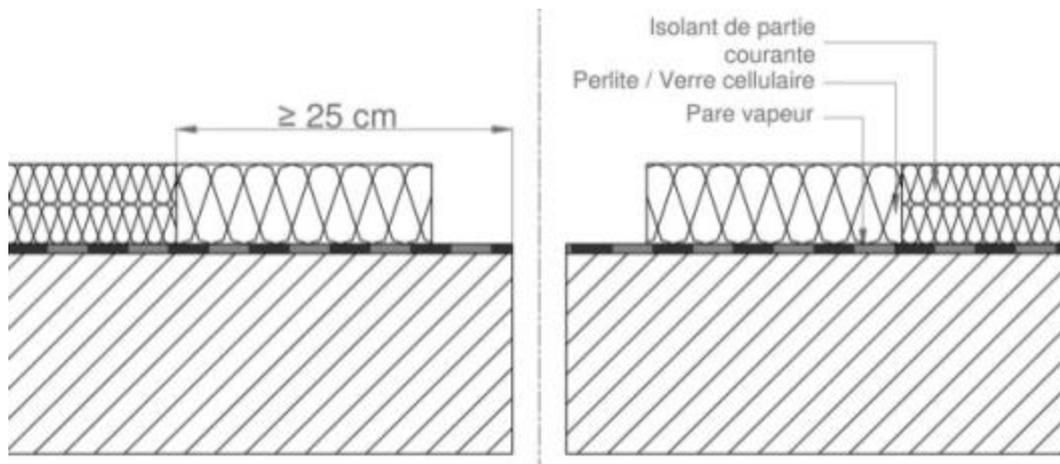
Terrasses accessibles aux piétons et séjour - Feuille sur support isolant rapporté
